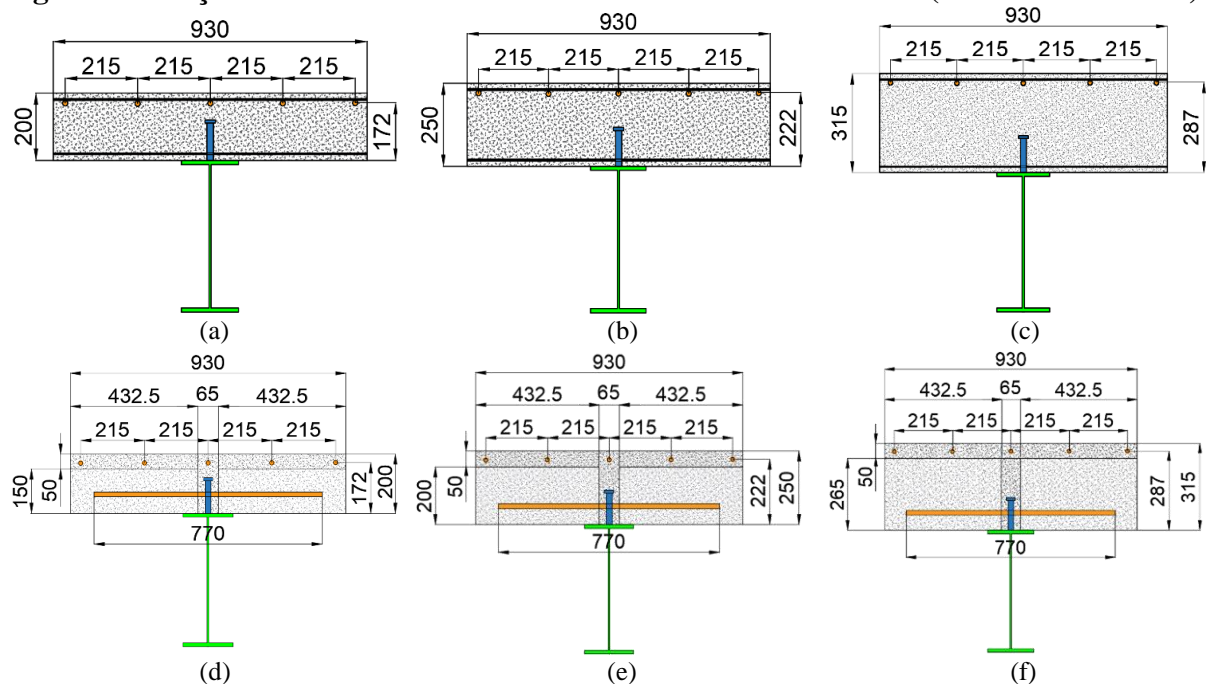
Detalhes das lajes alveolares (dimensões em mm)
